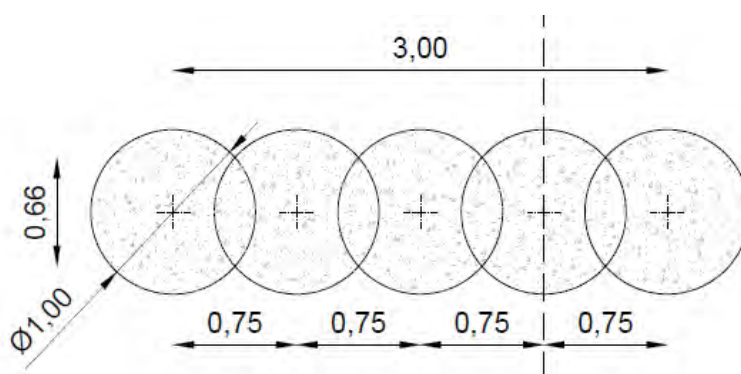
Schema planimetrico di realizzazione delle colonne compenstrate
